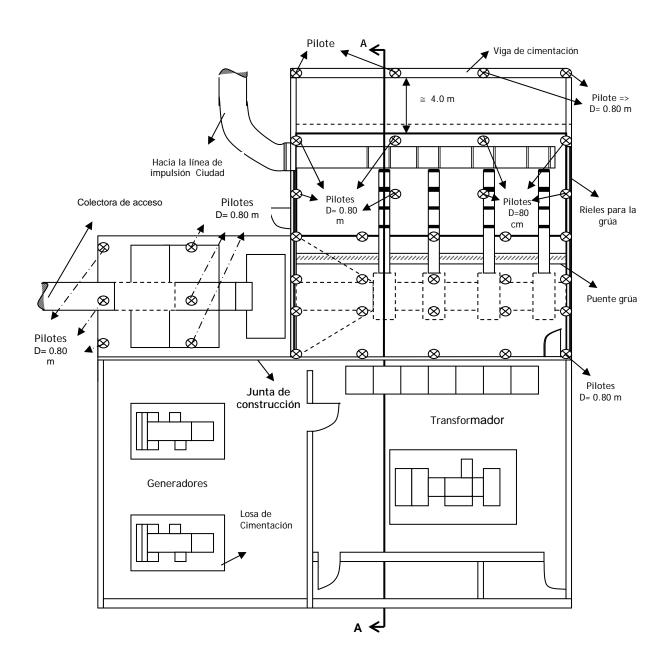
Estación de Bombeo Juan Díaz - Vista en Planta
